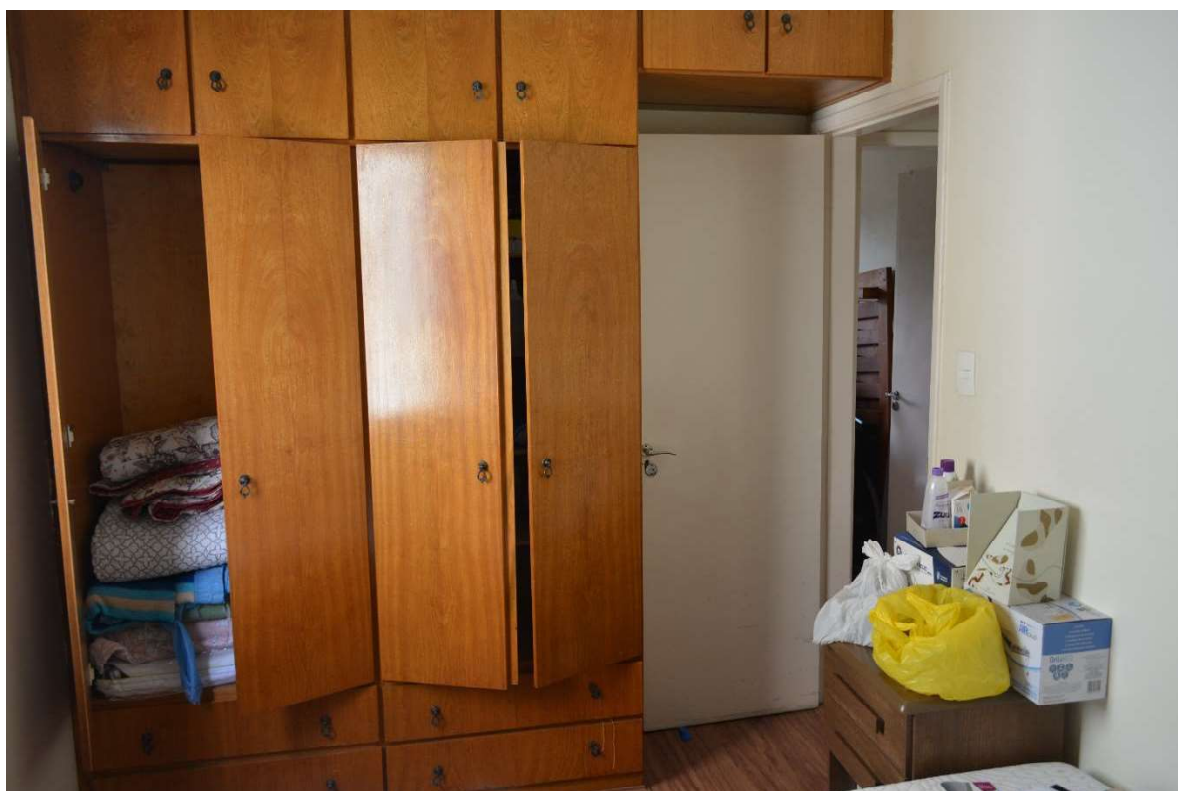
VISTA OPOSTA DO DORMITÓRIO 1, OS ARMÁRIOS TAMBÉM SERÃO REMOVIDOS.
